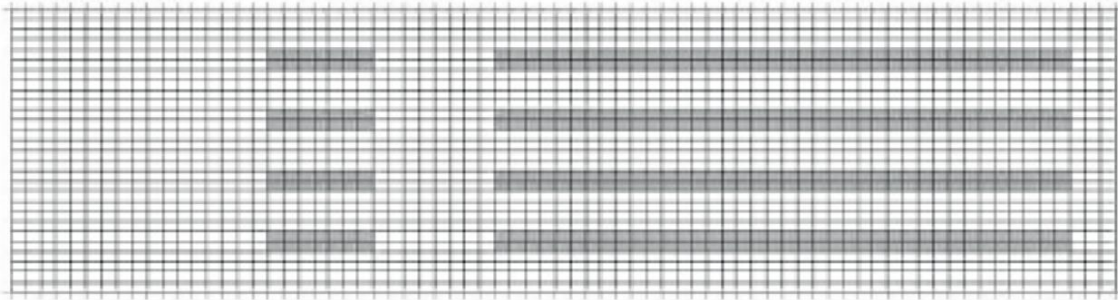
PLANTA DE CUBIERTA CON DIFERENCIACIÓN ENTRE PANELES DE VIDRIO Y OPACOS
